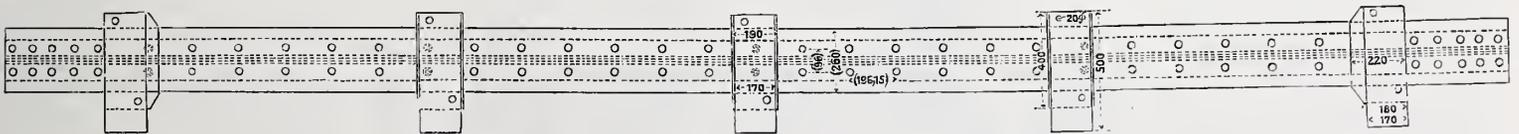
Grundriss des vorhandenen Querträgers mit den keilförmigen Unterlagsplatten.
